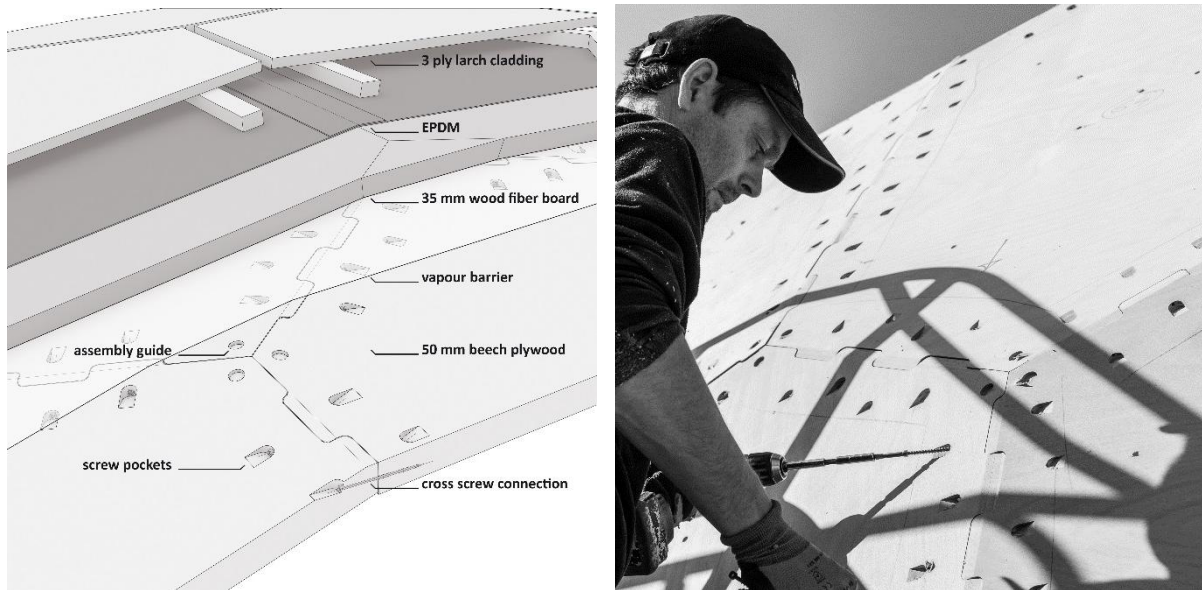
Der Forstpavillon besitzt einen komplett digital generierten und fabrizierten Konstruktionsaufbau. Oberhalb der tragenden Plattenkonstruktion befinden sich Dampfsperre, Holzweichfaserplatten, EPDM, Konterlattung, und Lärchen-3-Schicht-Platten.
